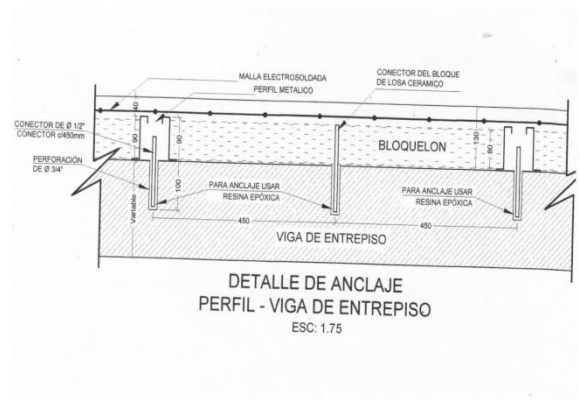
Detalle de anclaje entre perfil y viga de entrecimiento, fuente propia
